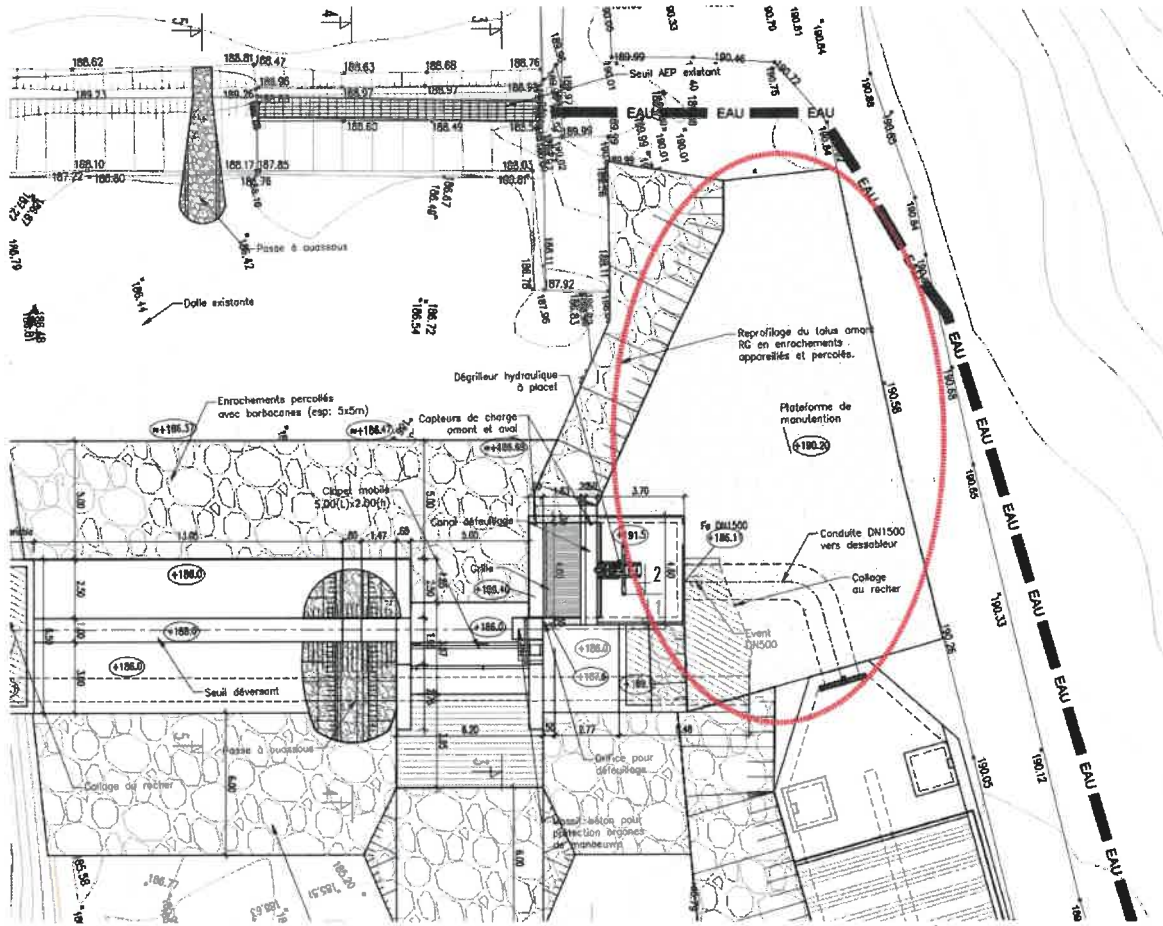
plateforme d'entretien et d'accès à la prise d'eau projetée
